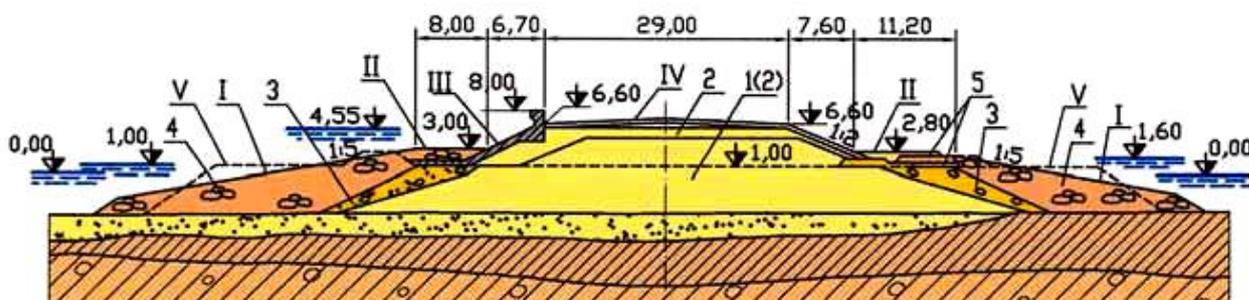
Поперечный профиль каменно-земляной защитной дамбы Санкт-Петербурга от наводнений: I – пологий динамически устойчивый откос; II – волногасящая берма; III – железобетонные плиты крепления верхового откоса; IV – железобетонная волноотбойная стенка; V – поперечный профиль первоочередной отсыпки скального грунта; 1 – мореный суглинок полезных выемок; 2 – песчаный грунт; 3 –
